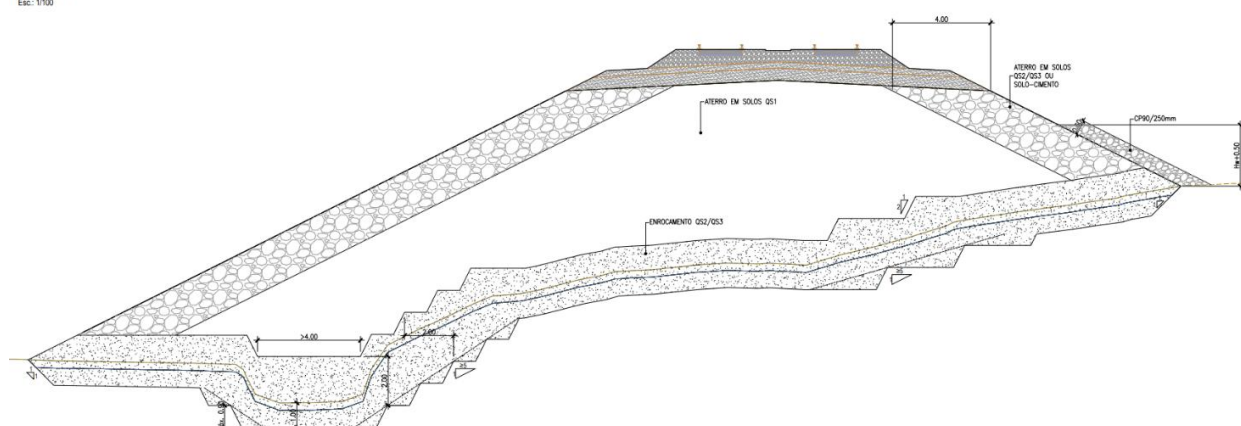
Perfil transversal tipo do aterro zonado adotado no subtroço 4
